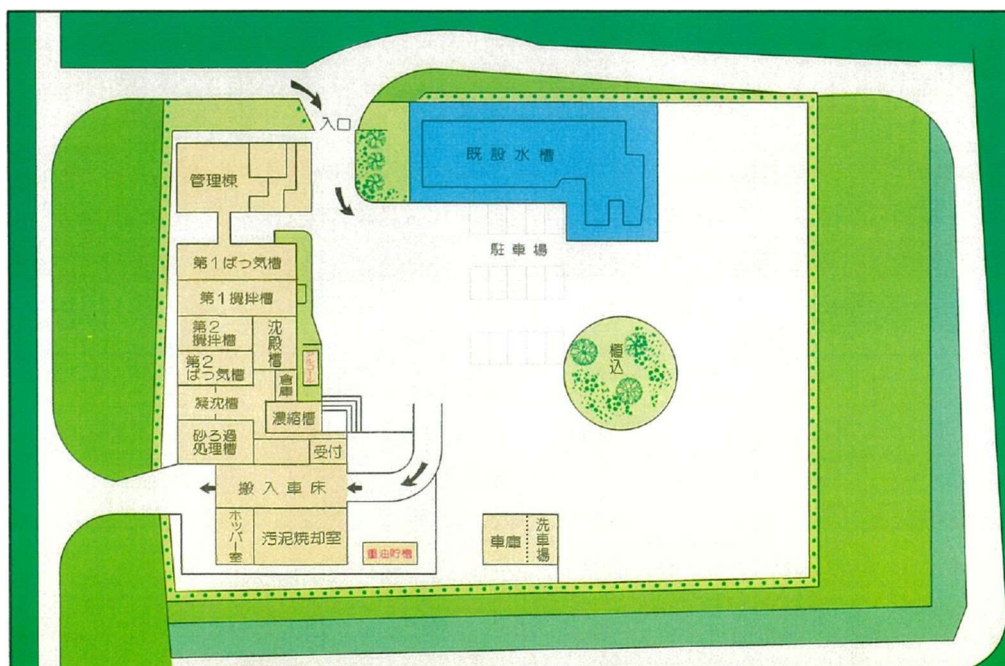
高鍋・木城衛生組合衛生センターの全体配置図
